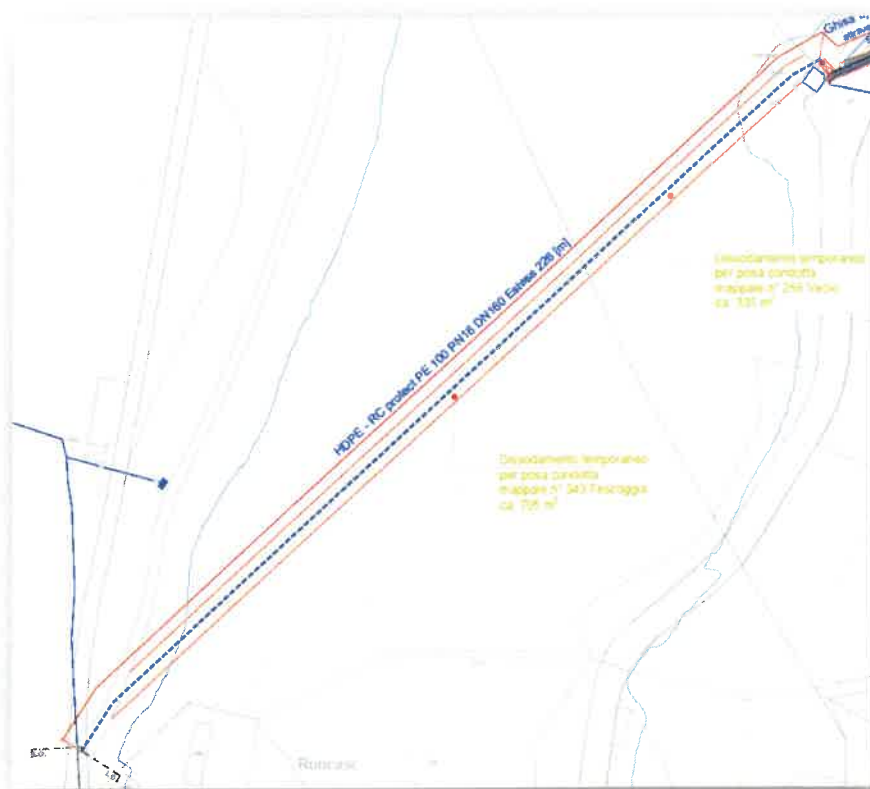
Planimetria con individuato il tracciato della condotta passante nel bosco (intervento 5)
